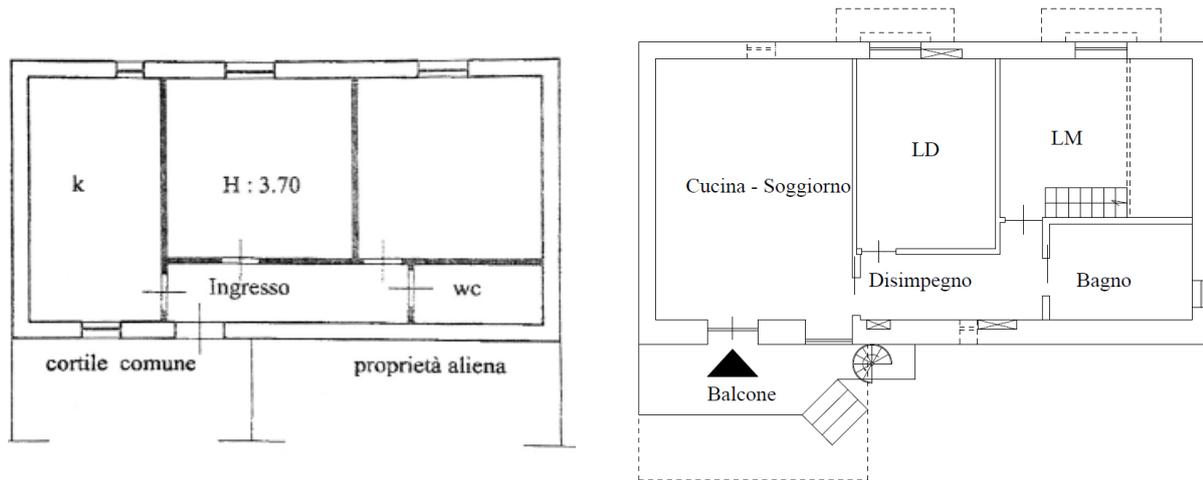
Planimetria catastale dell'immobile al piano rialzato e grafico del bene all'attualità.
